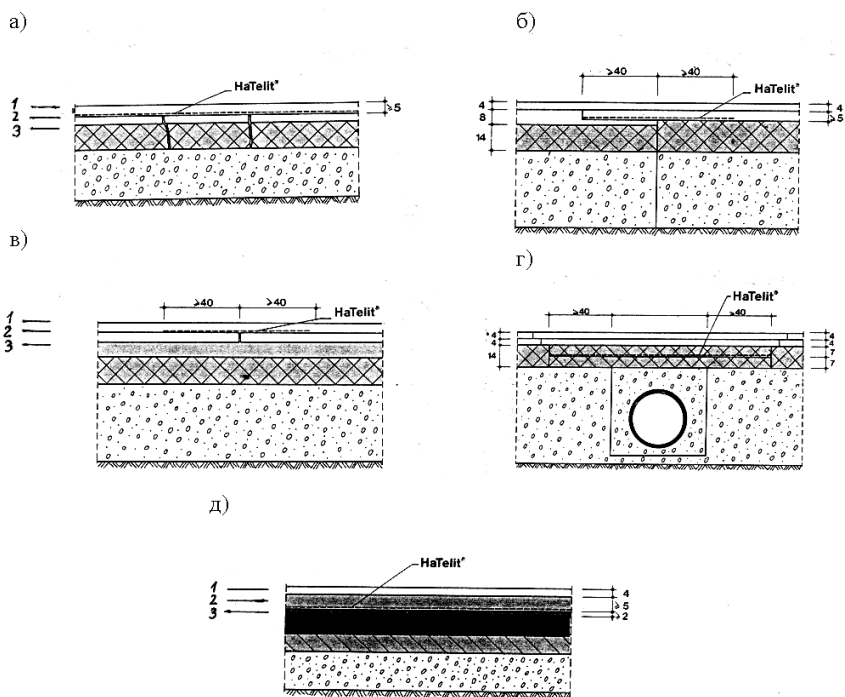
Армирование асфальтобетонного покрытия сеткой HaTelit:
